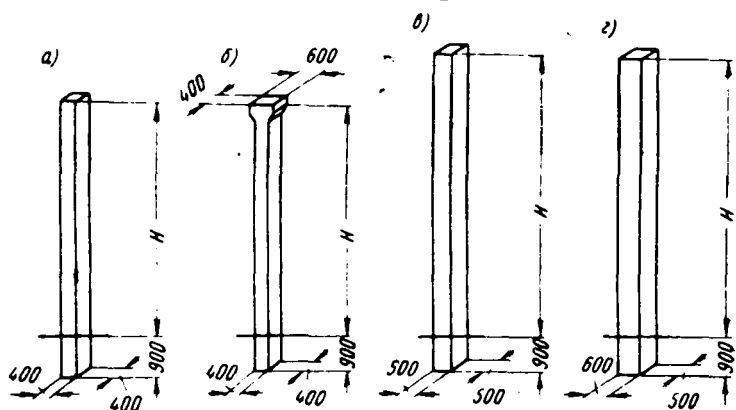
Типовые колонны прямоугольного сечения серии КЭ-01-49 для зданий без мостовых кранов
